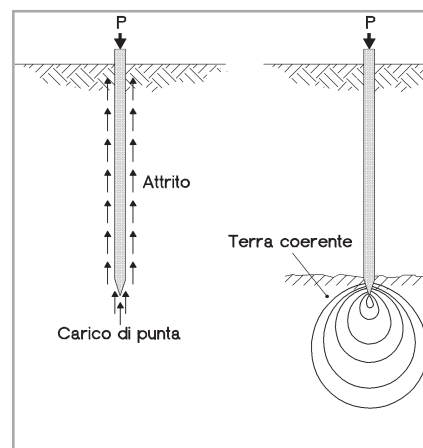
Rappresentazione schematica delle tensioni agenti su un palo di fondazione
